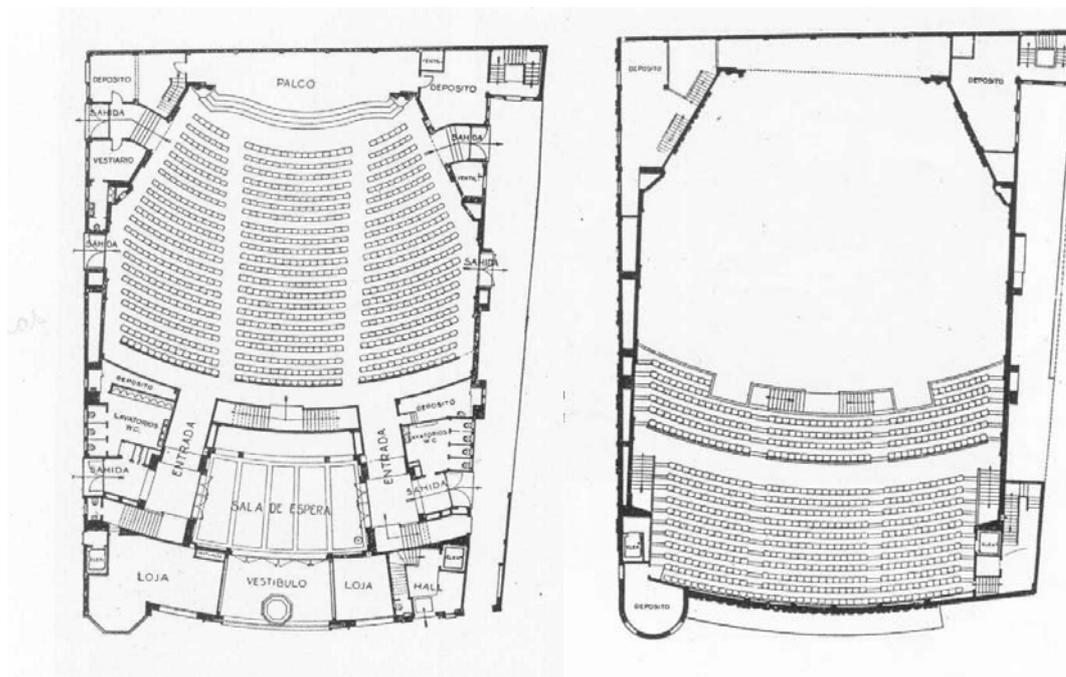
Cine Metro Passeio (Rio de Janeiro) planta do térreo e do balcão.
